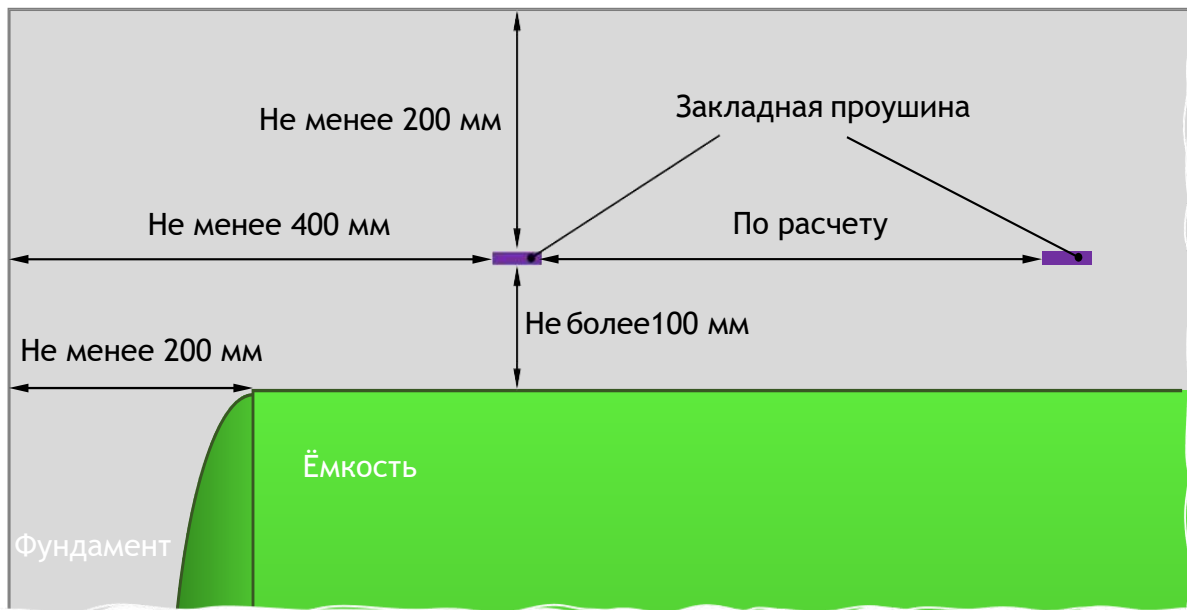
Закладка проушин на фундаментной плите (вид сверху)
